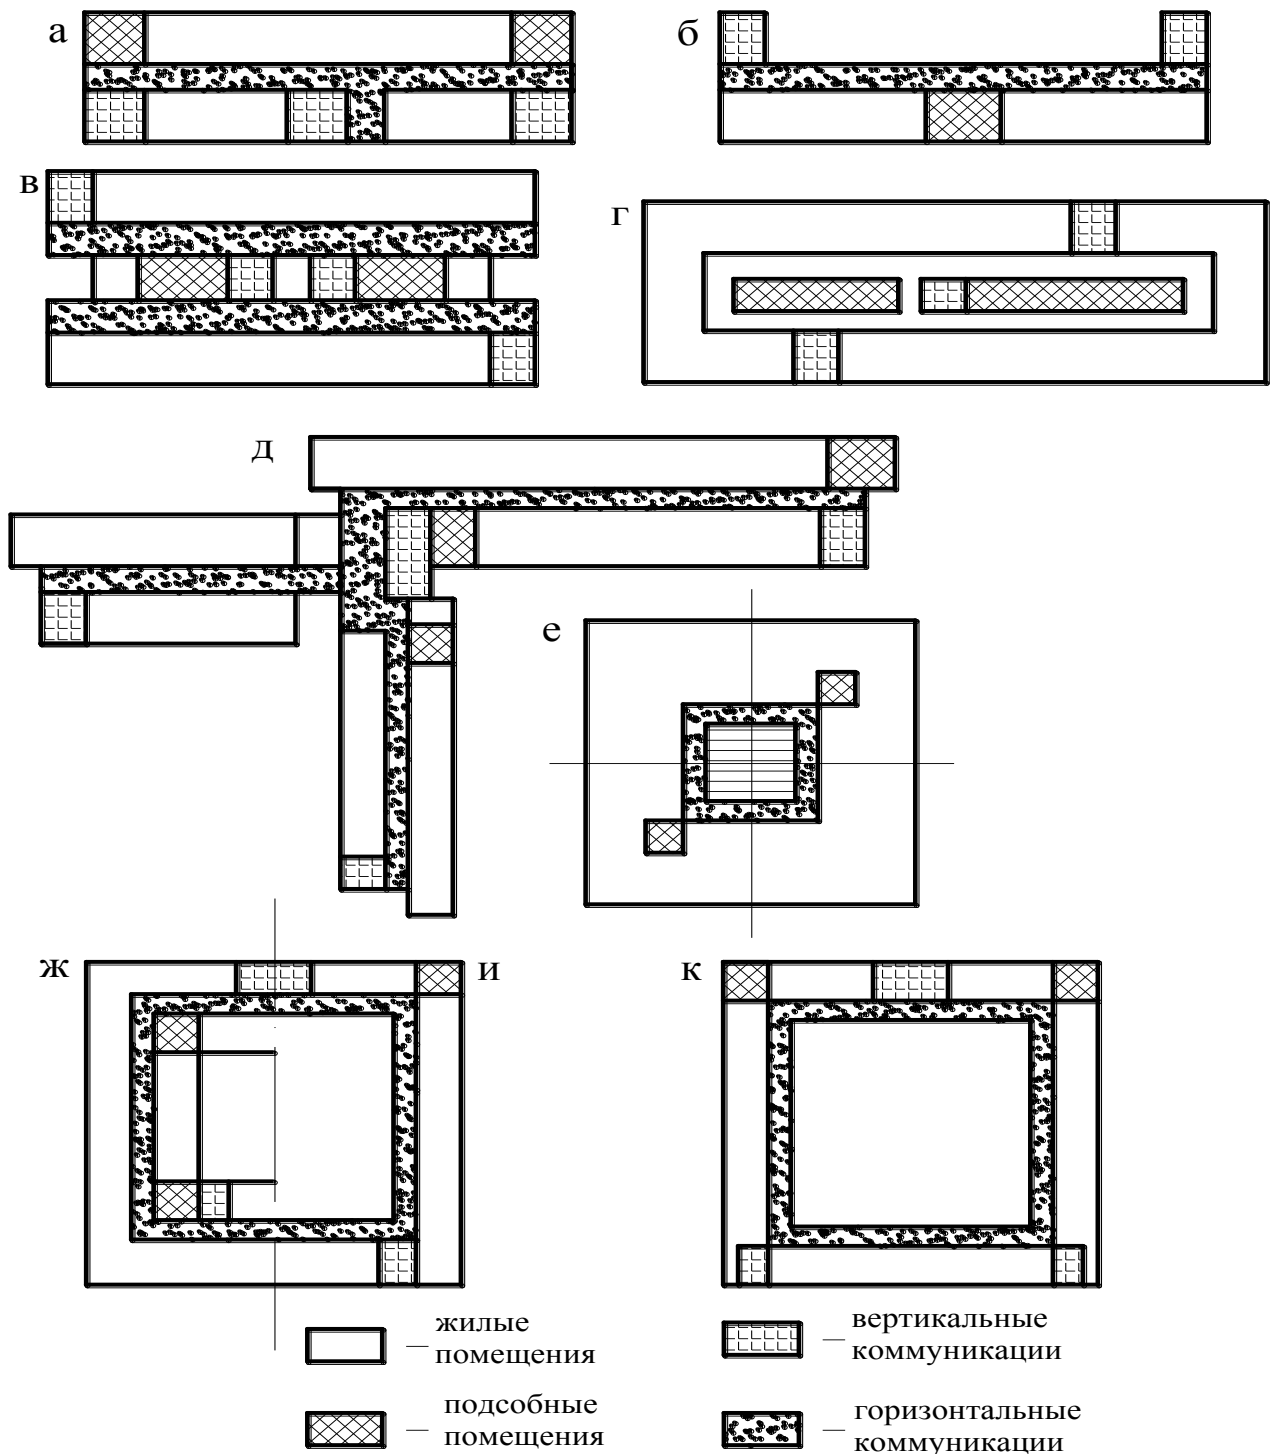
Планировочные схемы жилых этажей гостиниц: а – коридорная; б – галерейная; в – двухкоридорная; г – коридорно-кольцевая; д – узловая; е – башенная; ж – атриумная с открытым двором; и – то же, с перекрытием атриума в уровне первого этажа; к – то же, в уровне покрытия здания
